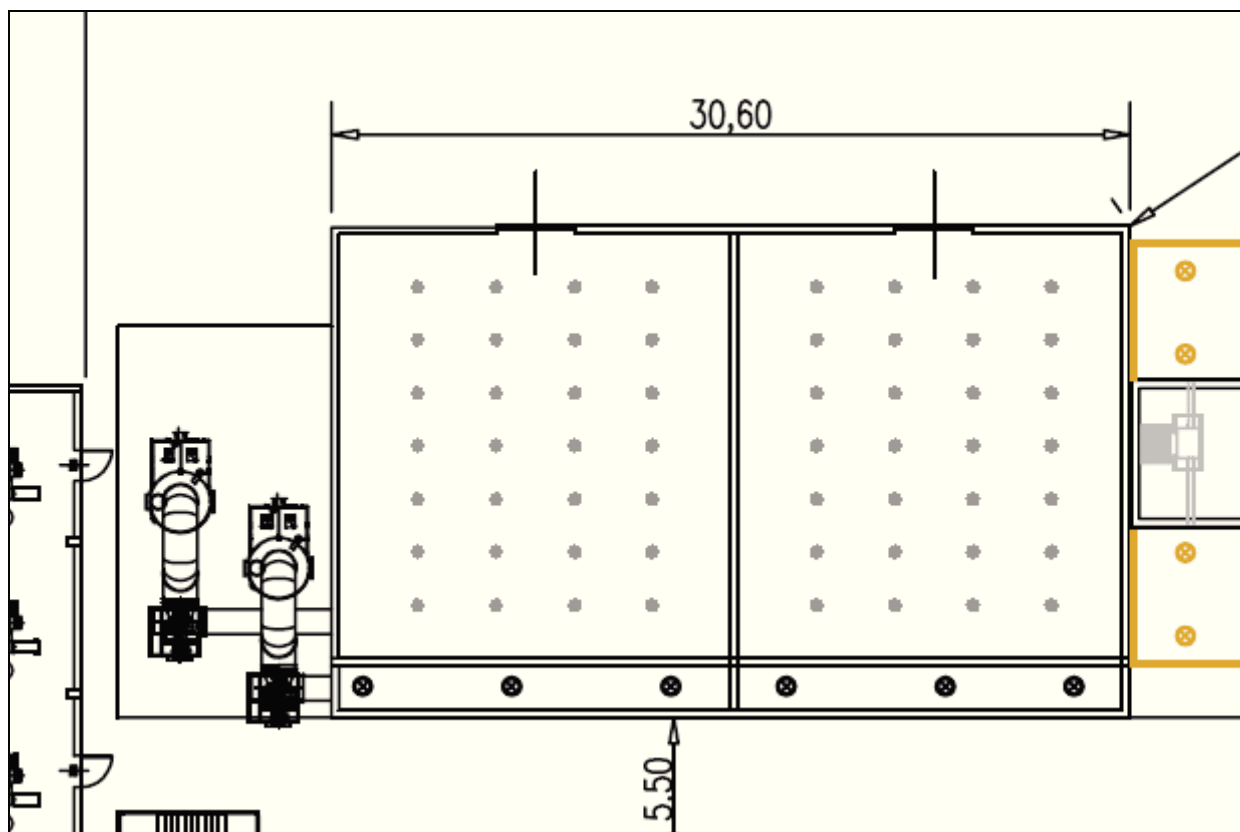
Stralcio planimetrico progettuale del biofiltro di nuova realizzazione.
